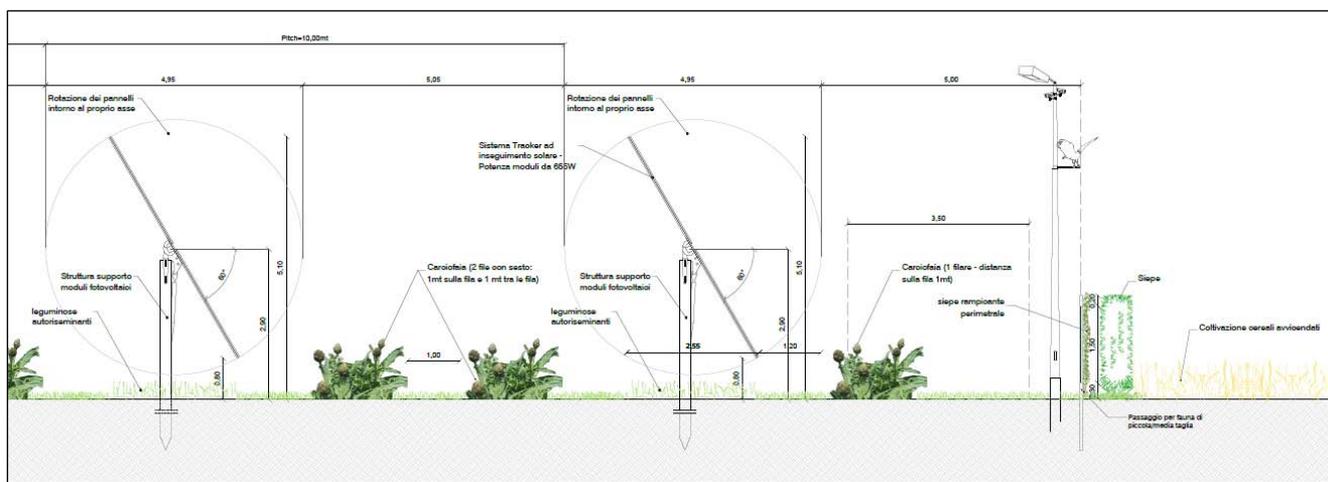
Sezione tipo coltivazione carciofi tra le fila delle strutture
